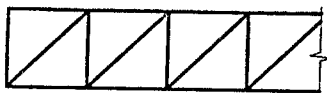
Розкісна ферма з висхідними розкосами
